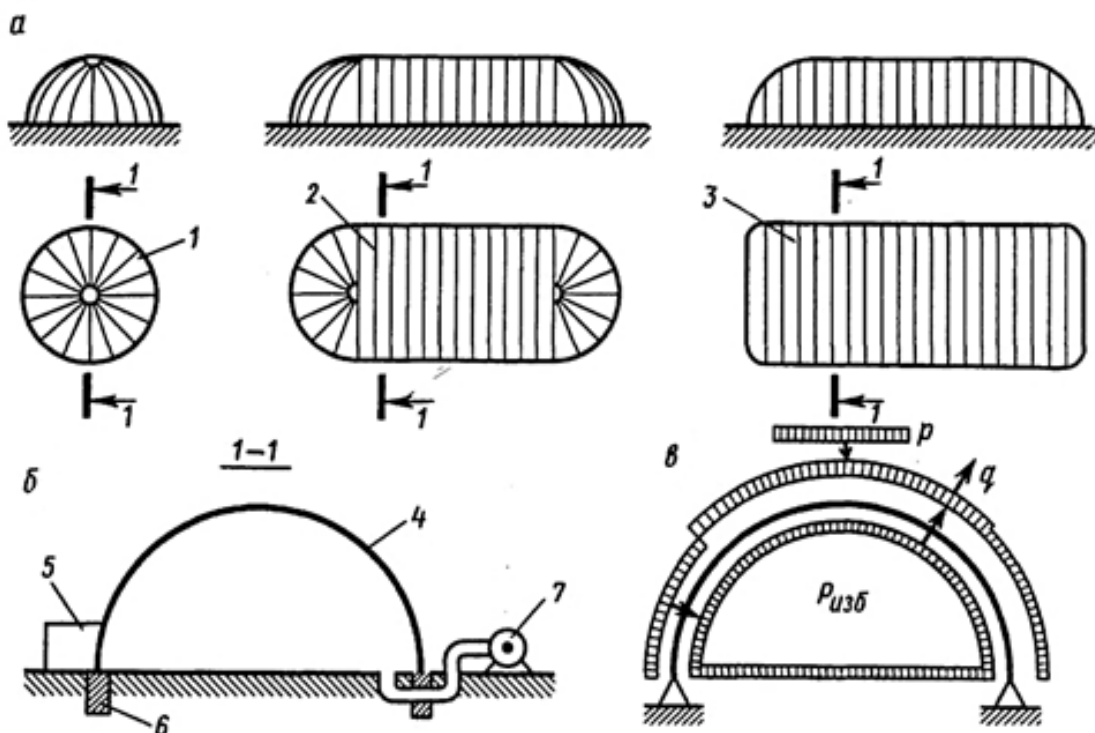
Воздухоопорные конструкции – пневмооболочки:
